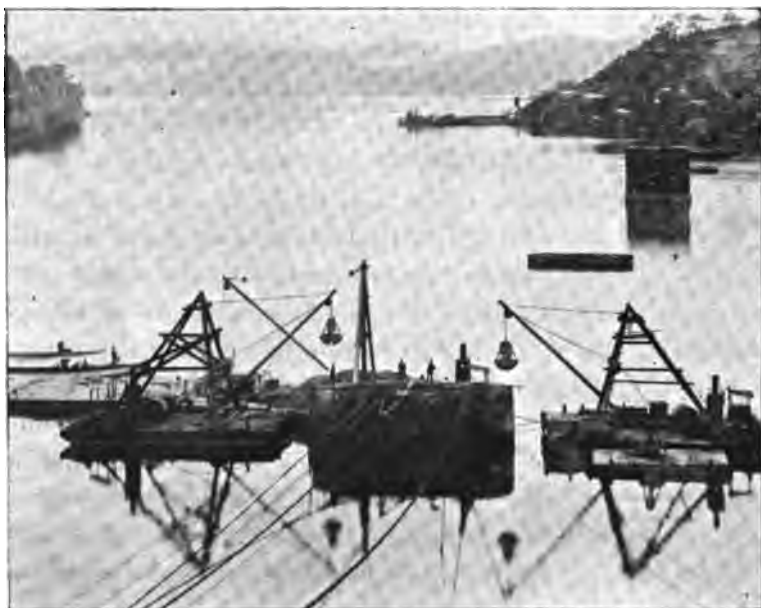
Pont de Hawkesbury. Fondation de la pile II.
